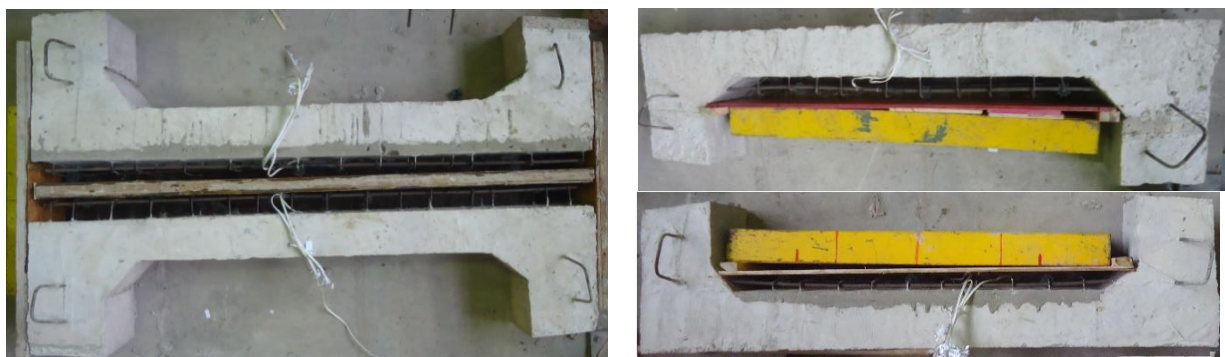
Extensómetros instalados al concreto (PTS; PTRS; PCS; PCSR respectivamente).
